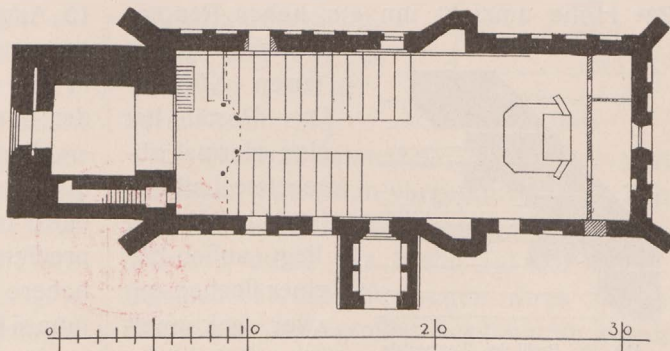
Kirche zu Baumgarth. Grundriß 1:400.
